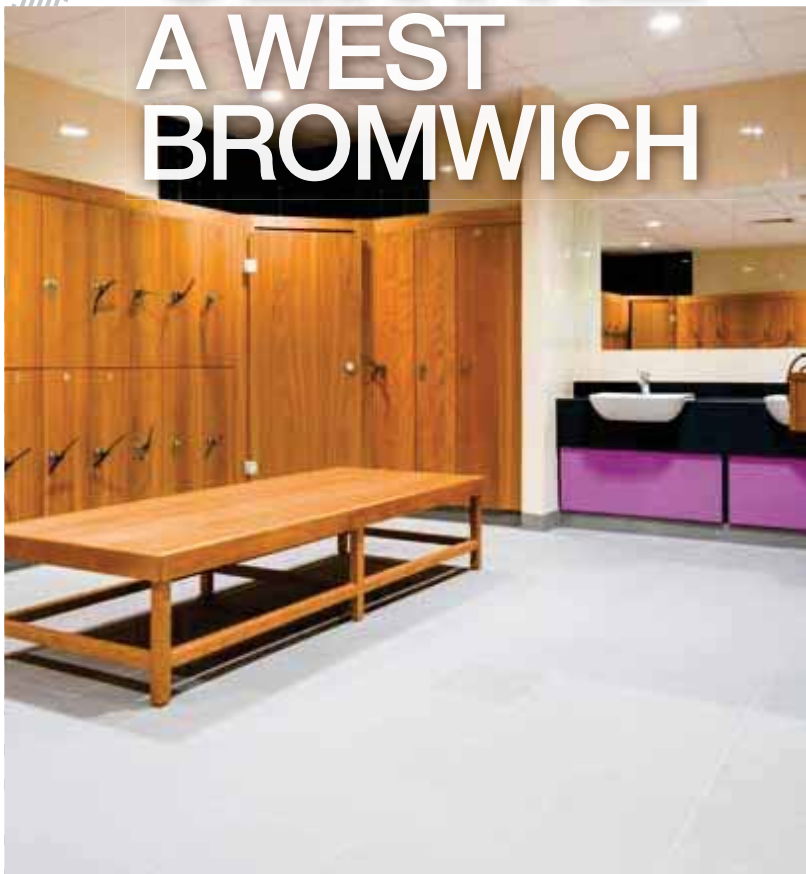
I giunti della pavimentazione sono stati sigillati con MAPEFLEX PU 30.
